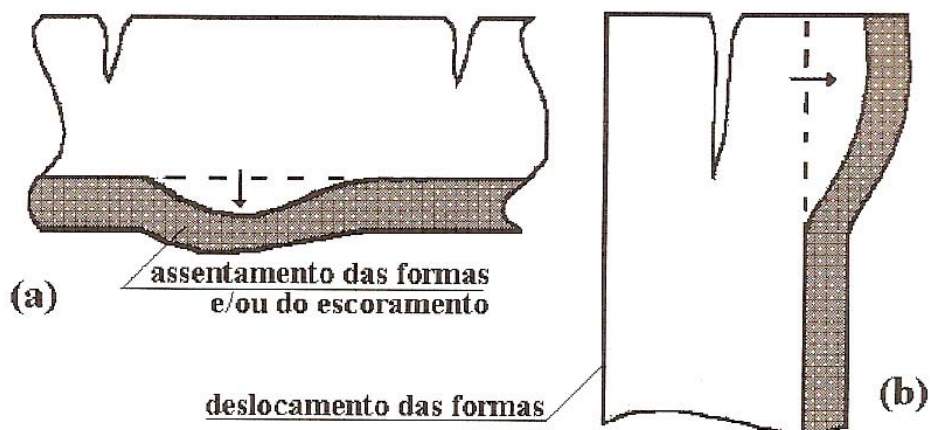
Fissuras de assentamento do concreto (Souza, 1999).
